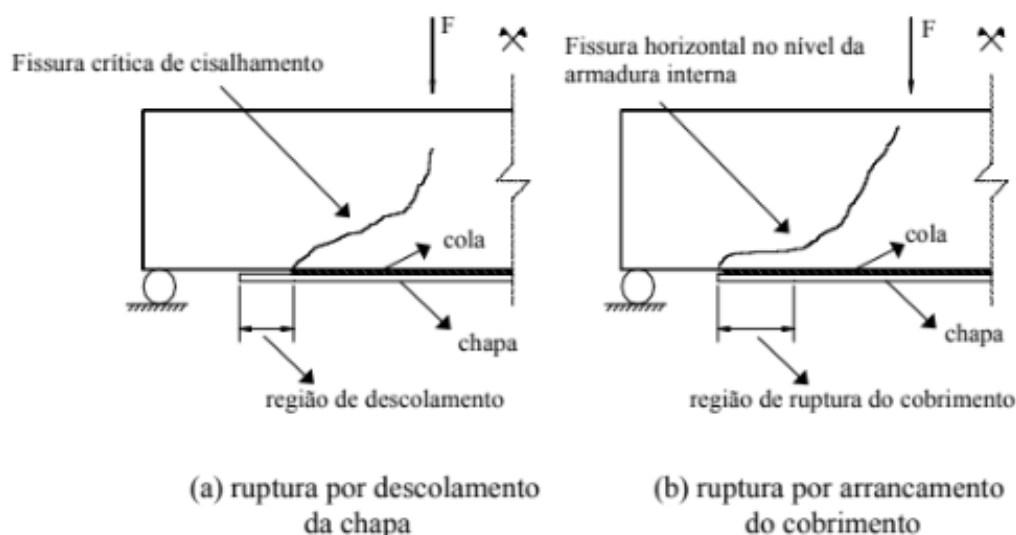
Problemas causados em vigas de concreto por descolamento do elemento metálico de reforço.
